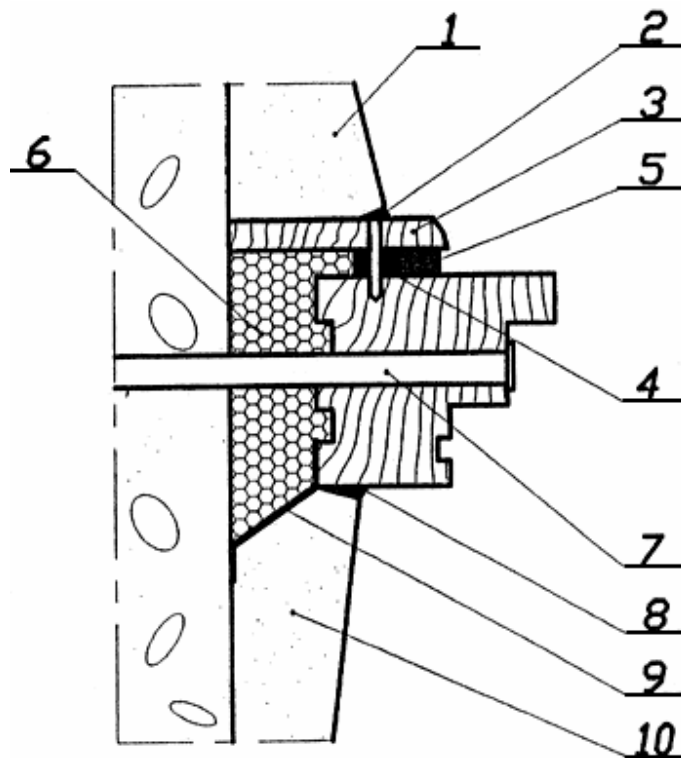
Узел бокового примыкания оконного блока к проему без четверти в стене из ячеистобетонных блоков с отделкой наружных и внутренних откосов штукатурным раствором;
